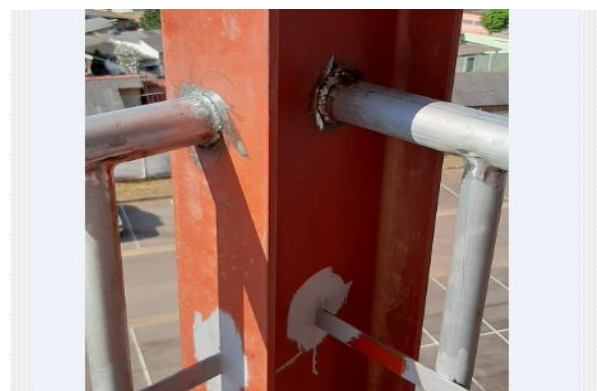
Detalhe da solda dos elementos do guarda-corpo nos pilares
